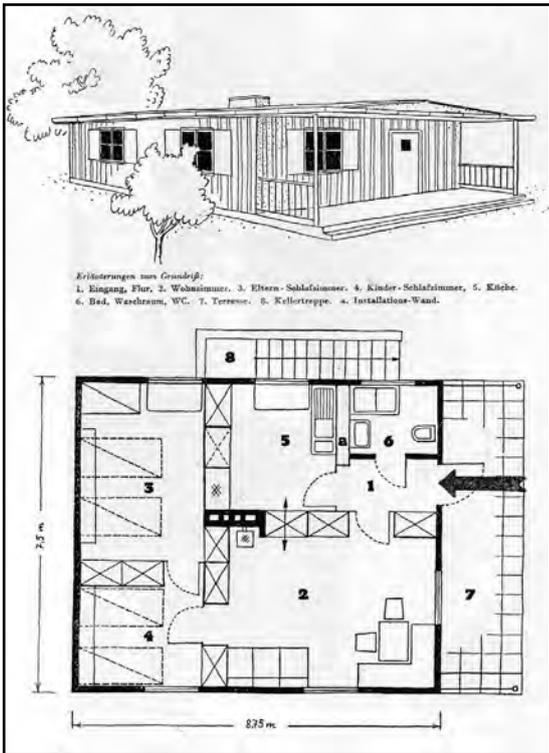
| Stahlhaus Typ Homburg, Ausstellung „Das Fertighaus“, 1947
